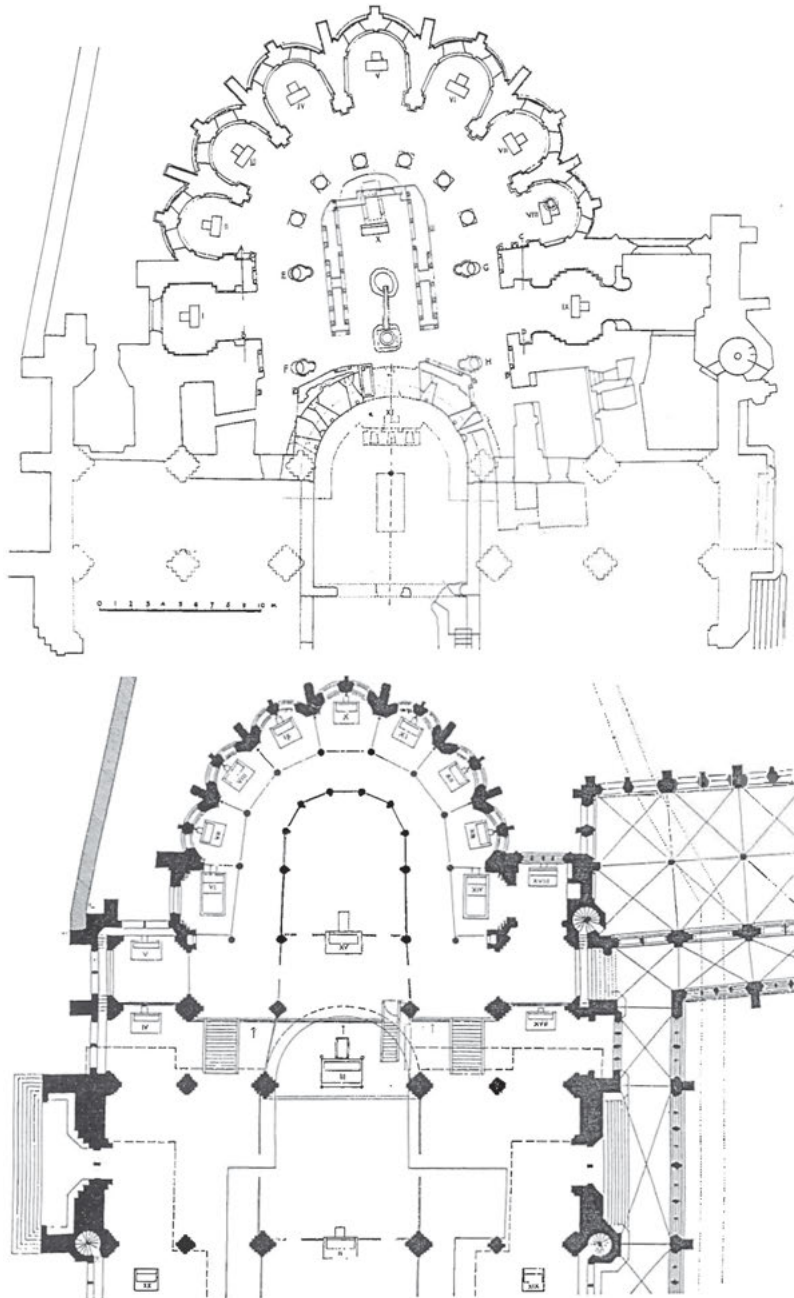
Abteikirche Saint-Denis: Grundrisse der Ostanlage mit Vierung: Krypta und Oberkirche nach Jules Formigé, *L'Abbaye royale de Saint-Denis. Recherches nouvelles*. Préface de Paul Léon, Paris 1960, S. 154f., Fig. 130: Oberkirche, und S. 180f., Fig. 165: Krypta.
